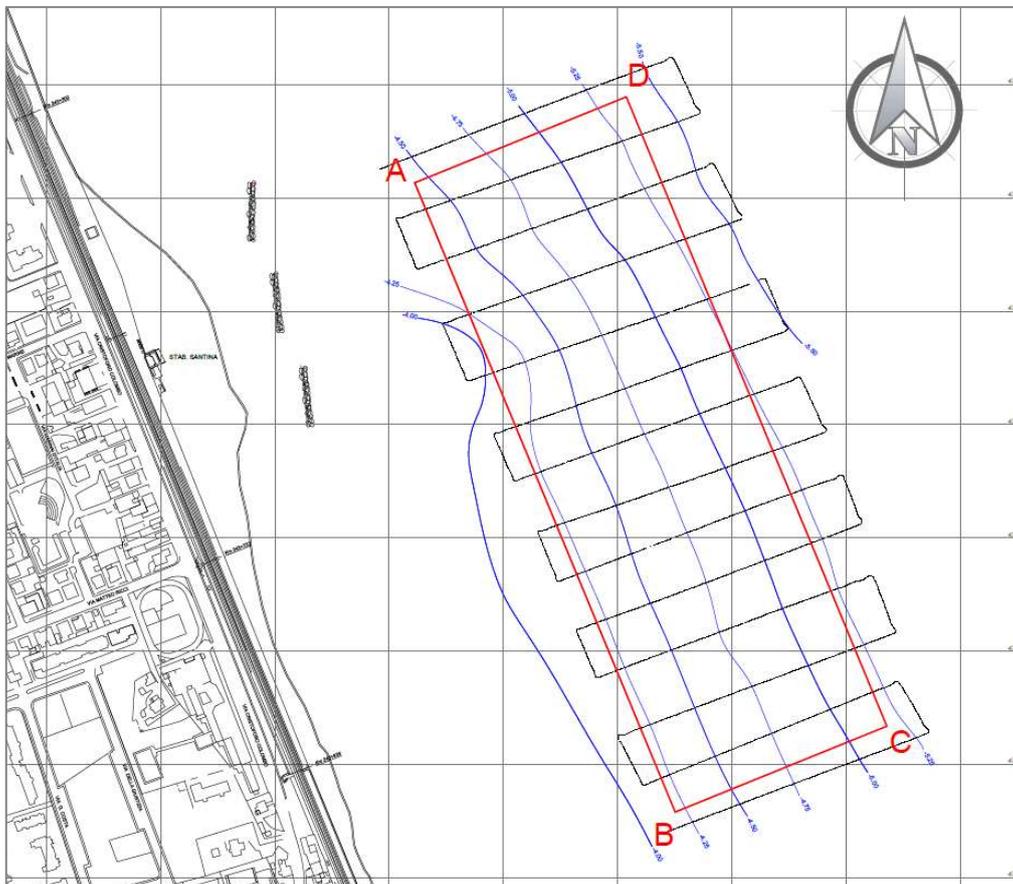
Dettaglio rilievo single beam area di ripascimento sommerso
